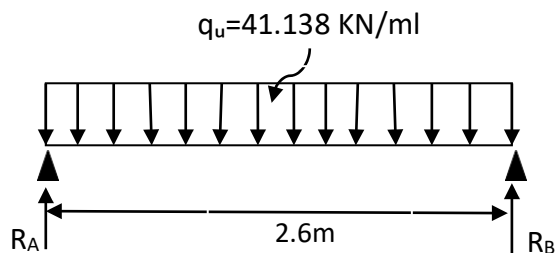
Schéma statique de la poutre palière horizontale à l'ELU.
